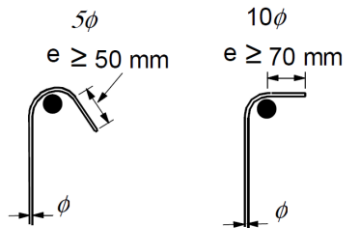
Figura C – Tipos de amarração para armaduras de esforço transverso. Adaptado de [14].
